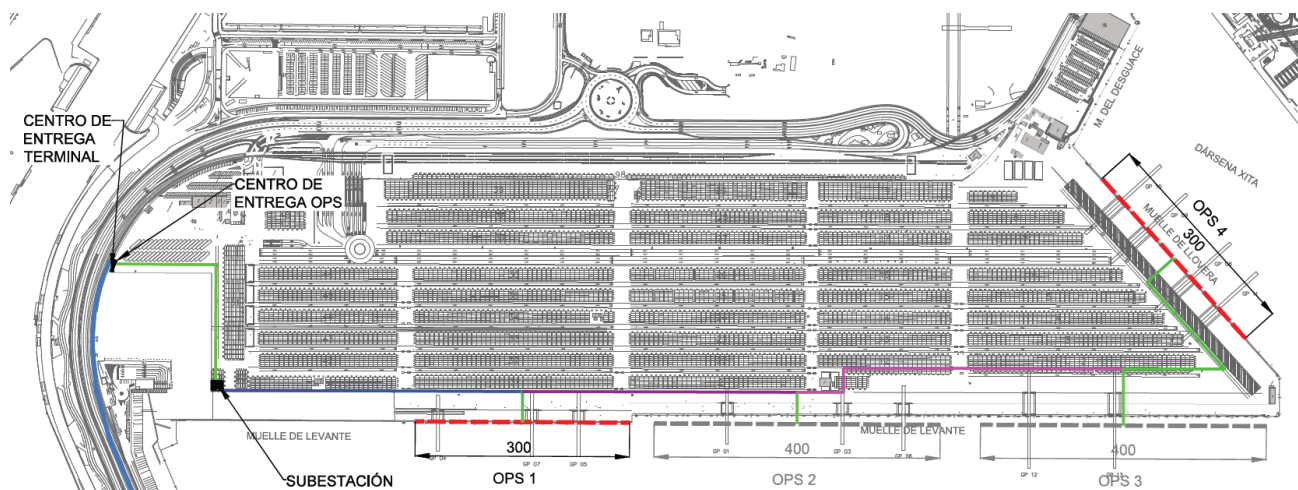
Plano General Proyecto OPS Muelles de Levante y Llovera.
